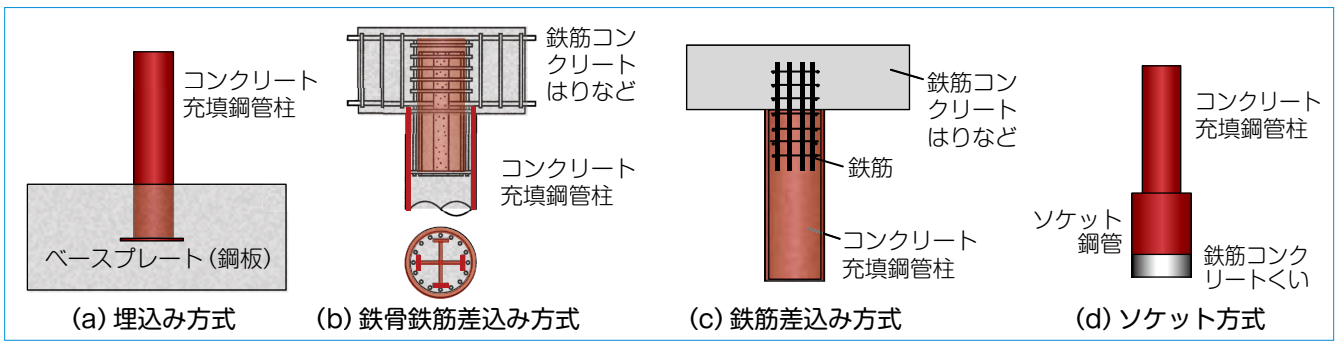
コンクリート充填鋼管部材と鉄筋コンクリート部材の接合部の例
